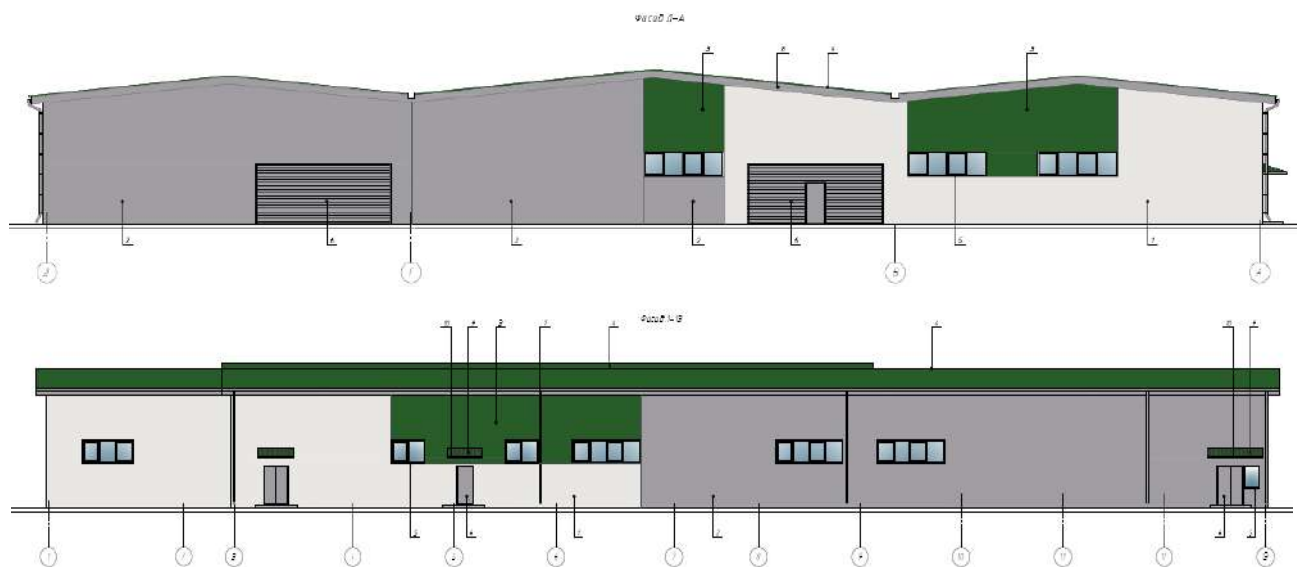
Схема фасадов лесопильного цеха (по ГП №1)
